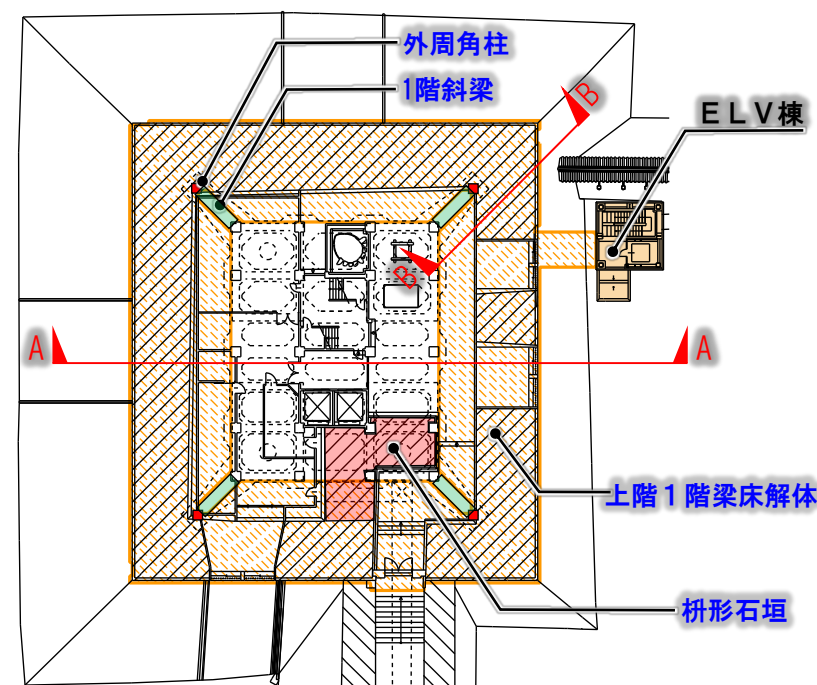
大天守解体部分地下平面図(ELV棟含)
